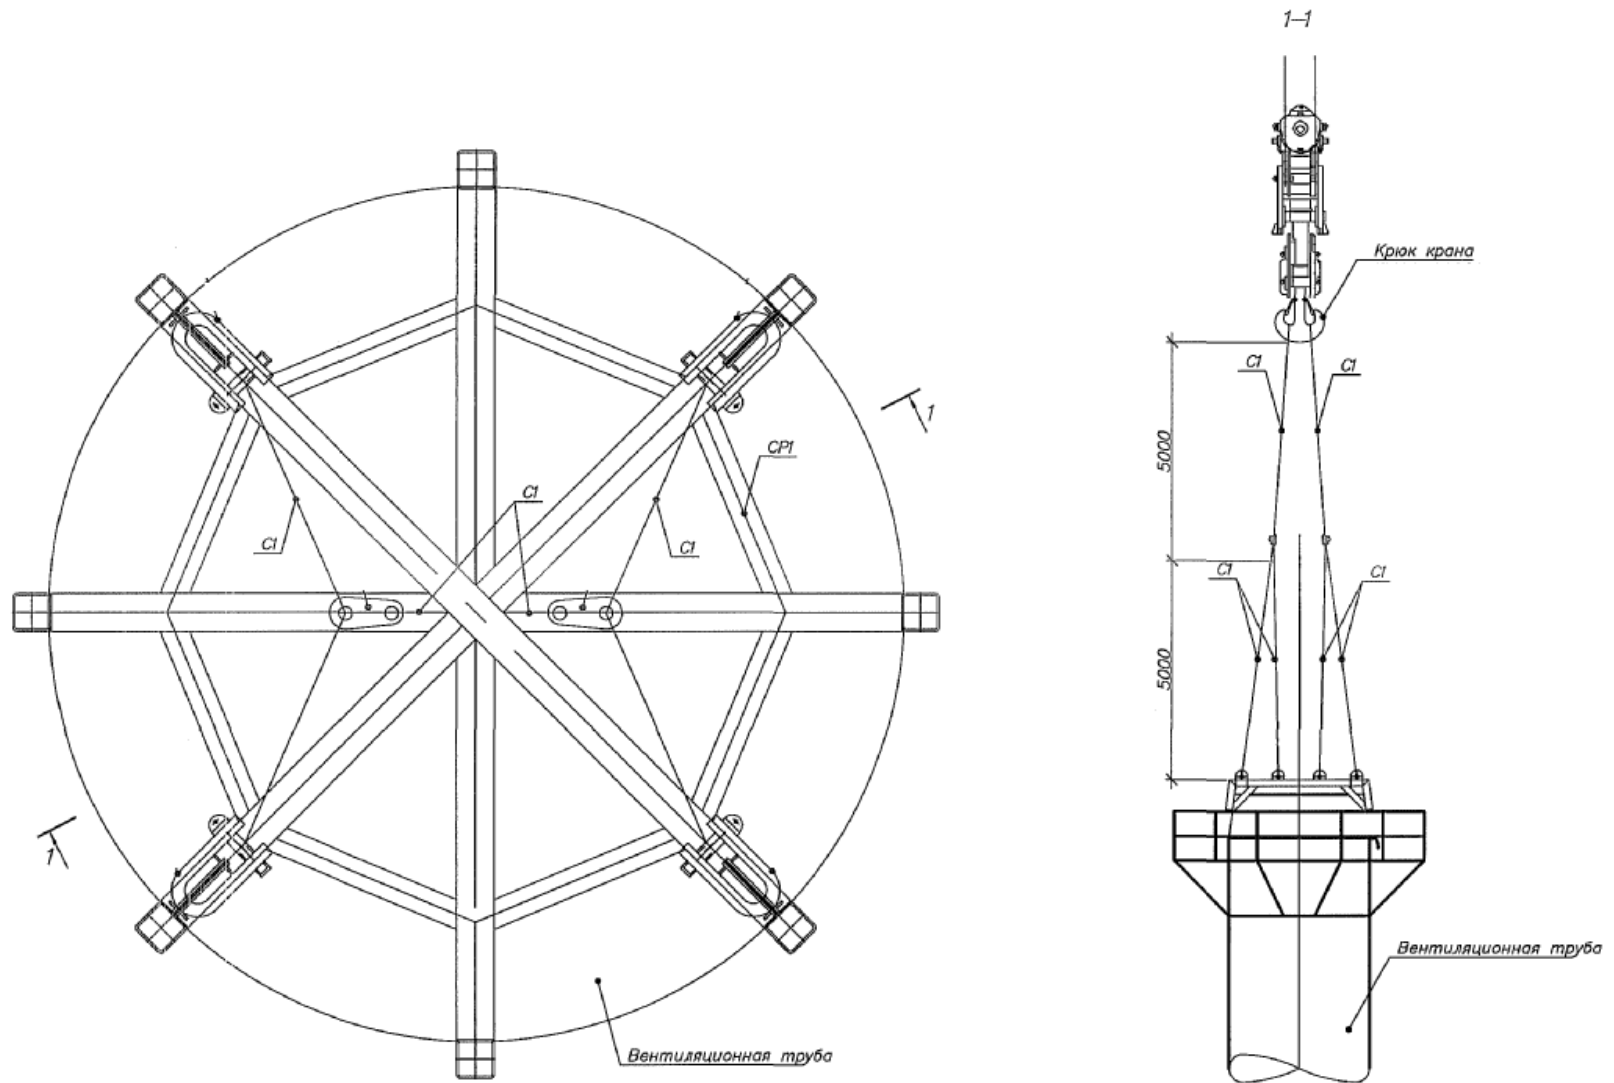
Схема строповки монтажного блока стальных строительных конструкций вентиляционной трубы
